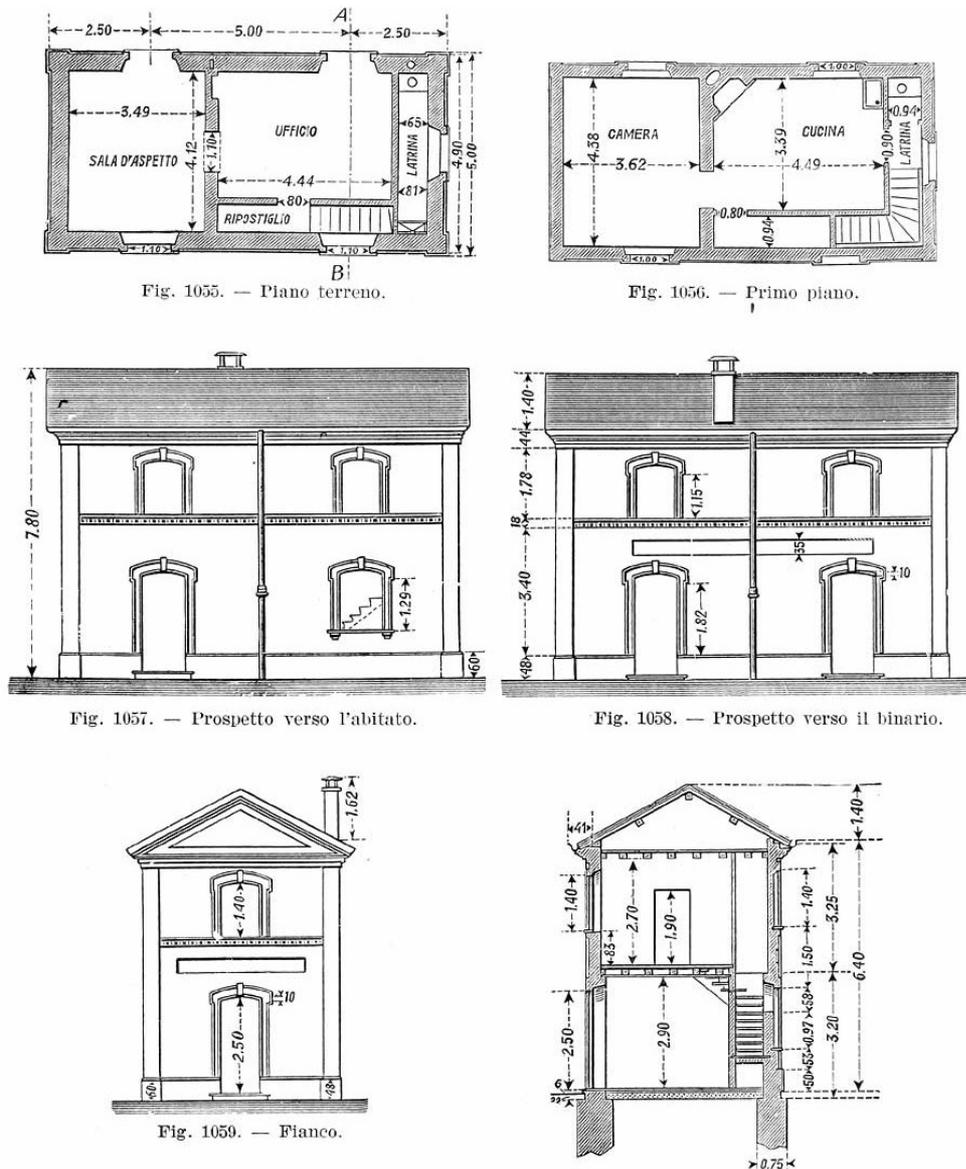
Tavola con Piante prospetti e sezione della Stazione di Cassola. Fonte: www.ferrovieitaliane.net, 1927
